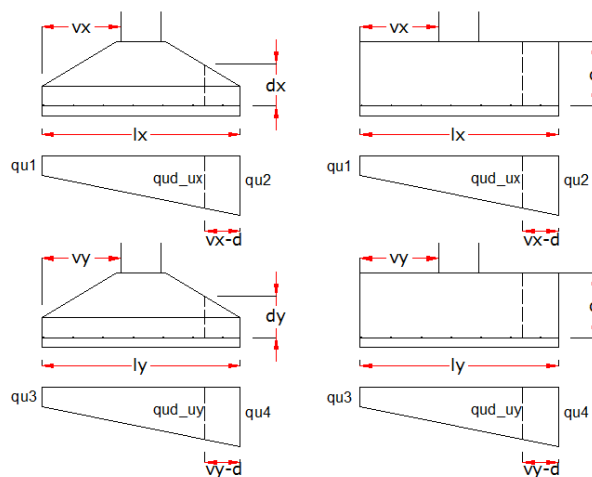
Tensión en sección crítica para el corte en una dirección, zapata tipo 1.
